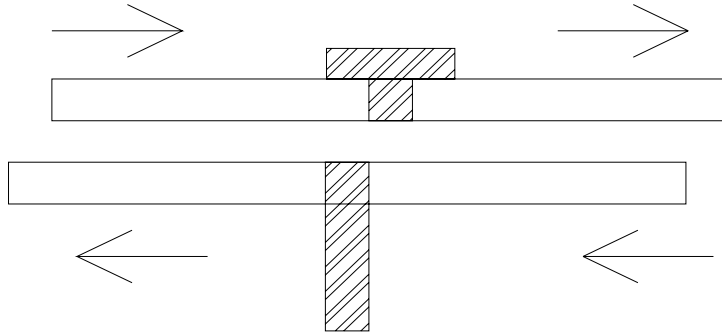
Detalhes de ligações metálicas com PAA's em Steel Frame
